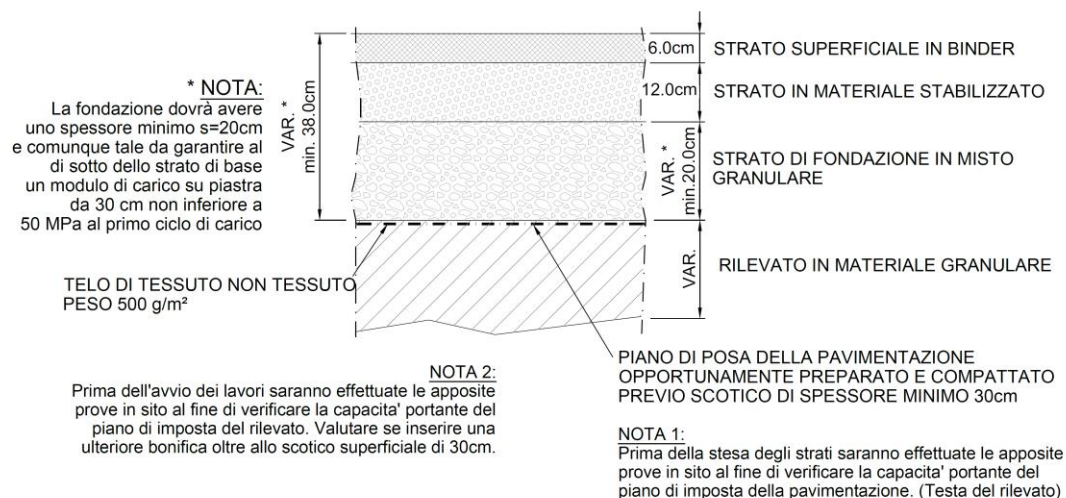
Dettaglio pavimentazione della strada di accesso all'imbocco GN01.
